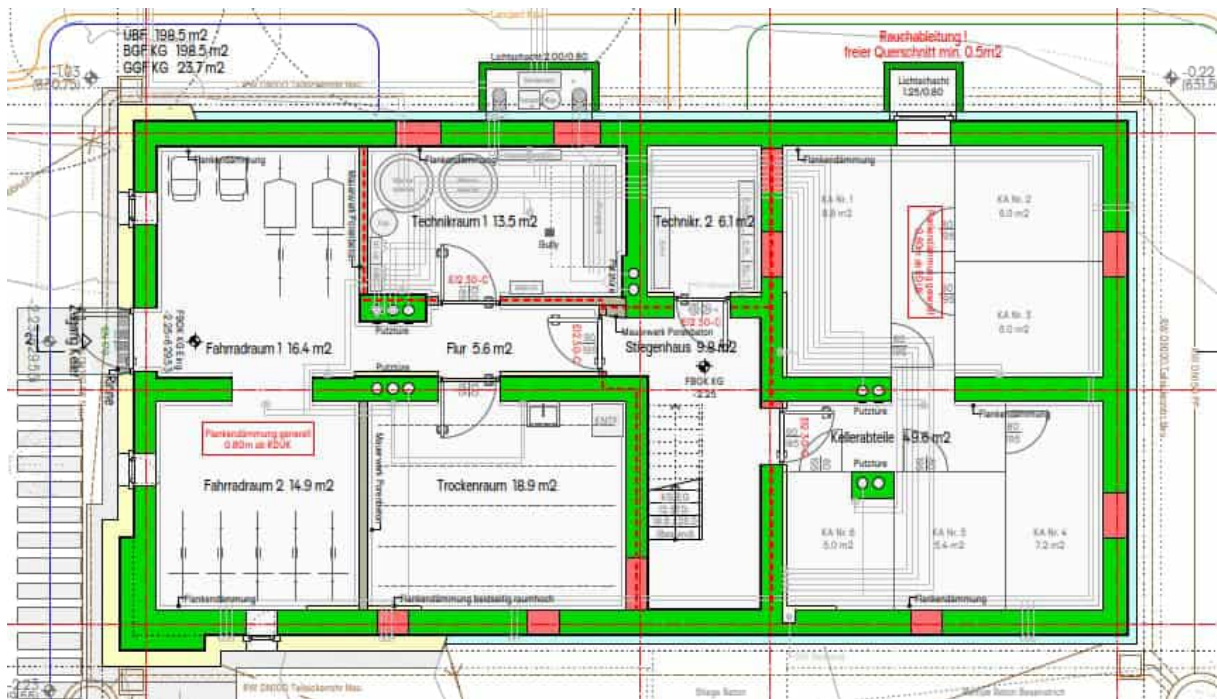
kleines Gebäude, Grundriss KG, ohne Maßstab; Johannes Kaufmann und Partner GmbH
